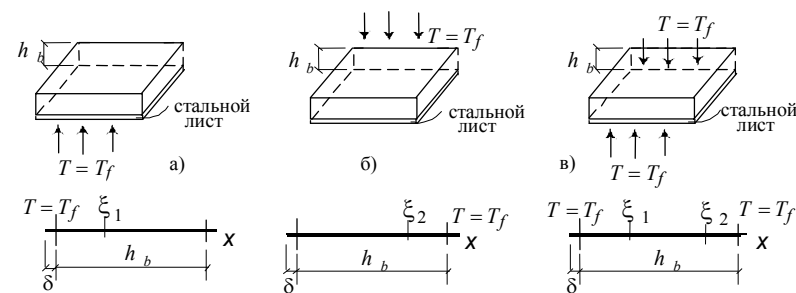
Расчетная схема сталебетонного перекрытия: температурное воздействие
